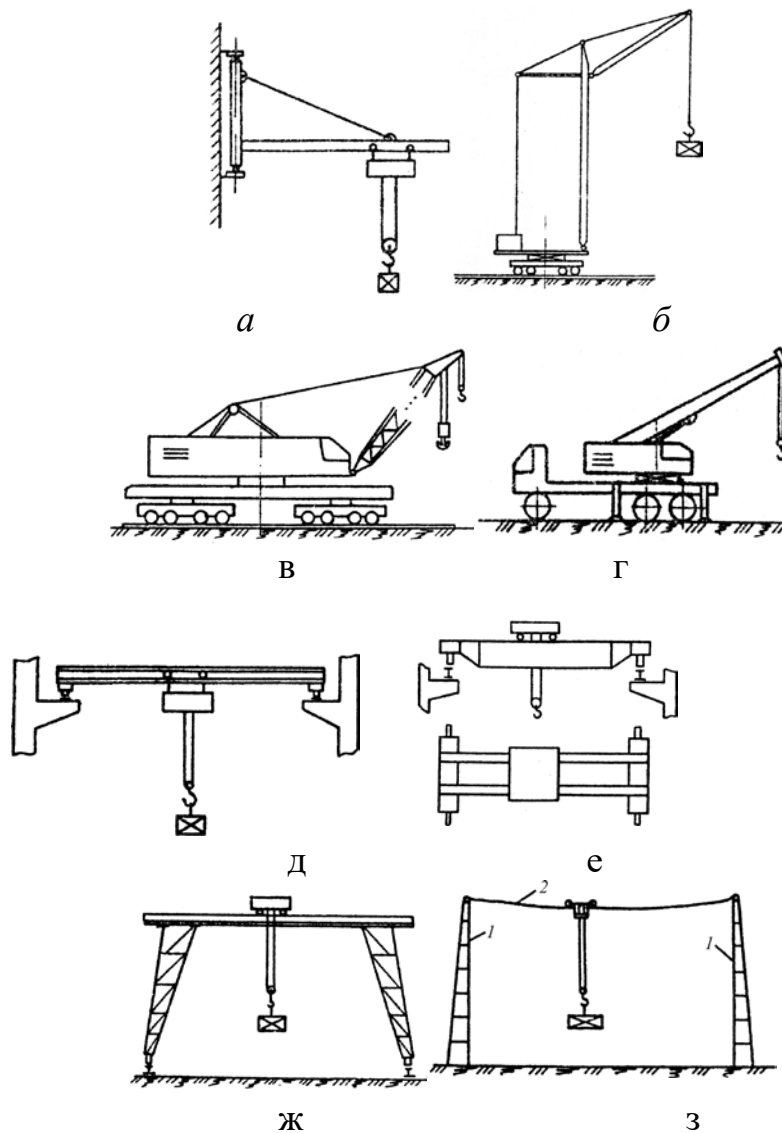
Грузоподъемные краны: а – консольный; б – башенный; в – автомобильный; г – железнодорожный; д – кран-балка; е – мостовой; ж – козловой; з – кабельный: 1 – высотные стойки; 2 – канат (кабель).
